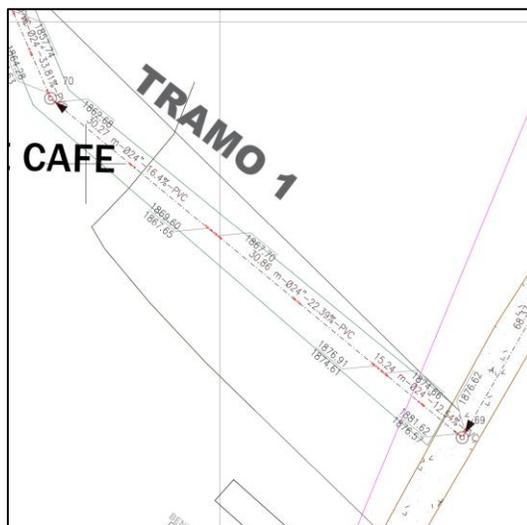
plano planta alcantarillado. Fuente: Consultoría.
